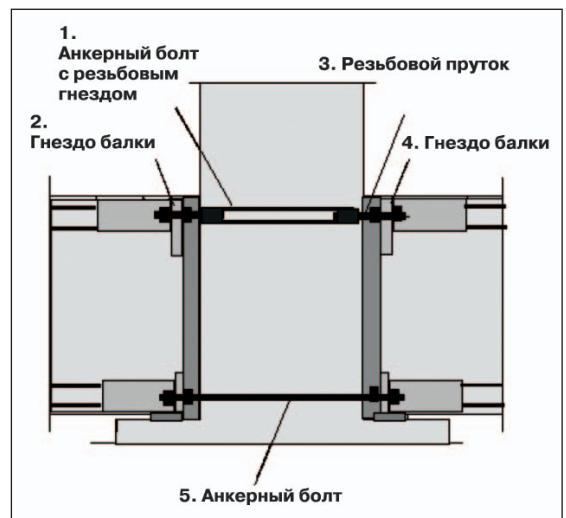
Внутренний узел балка-колонна при использовании сборных железобетонных изделий.
